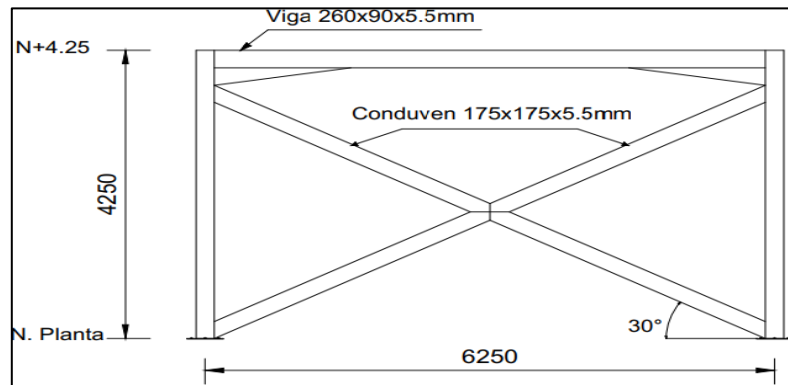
Pórtico entre N. planta y N+4.25, con arriostamiento lateral en "X", viga 260x90x5.5mm, y luz de 6.25m
